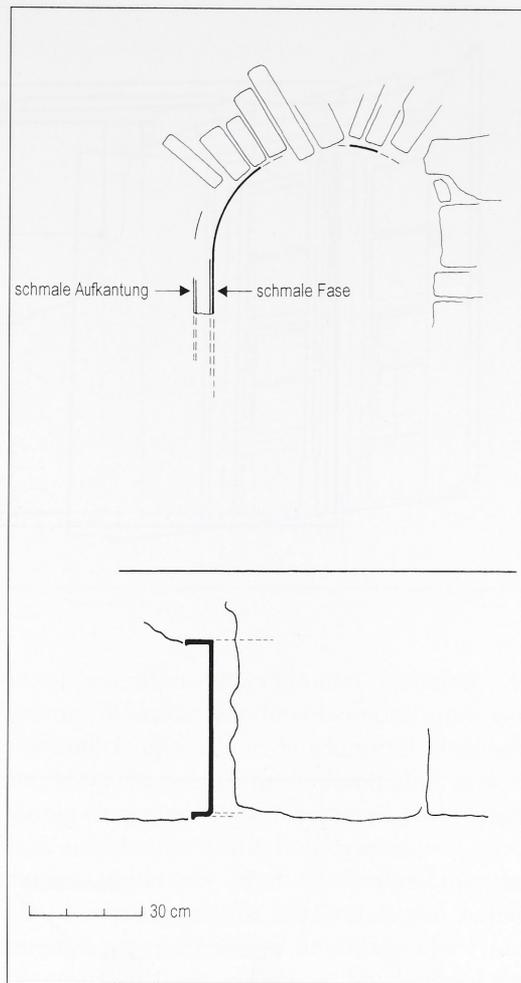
Rottweil, Suppengasse 2. Reste einer Stuckmörtellaibung von einer ehemals rundbogigen Fensteröffnung, in der südlichen Giebelwand im ersten Obergeschoß links gelegen. Außenansicht und Grundriß.
